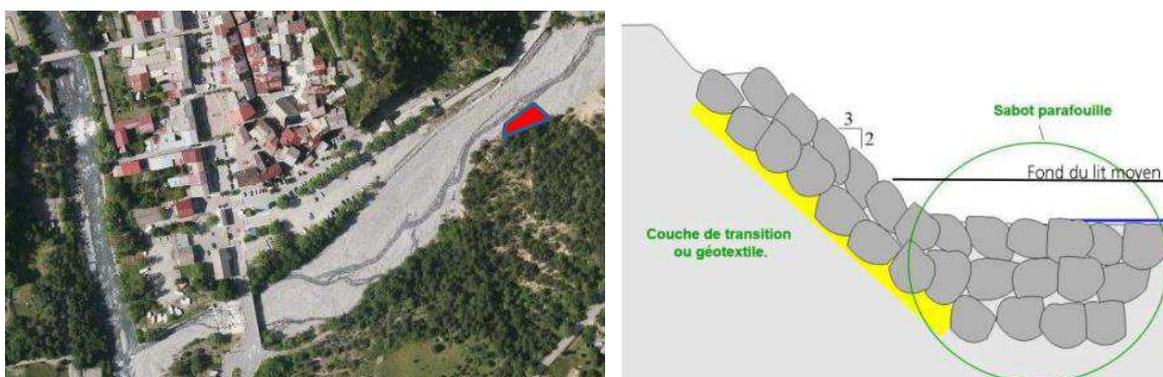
Préconisations de travaux : suppression du verrou hydraulique (à gauche) et renforcement de l'enrochement et du sabot parafouille (à droite)
